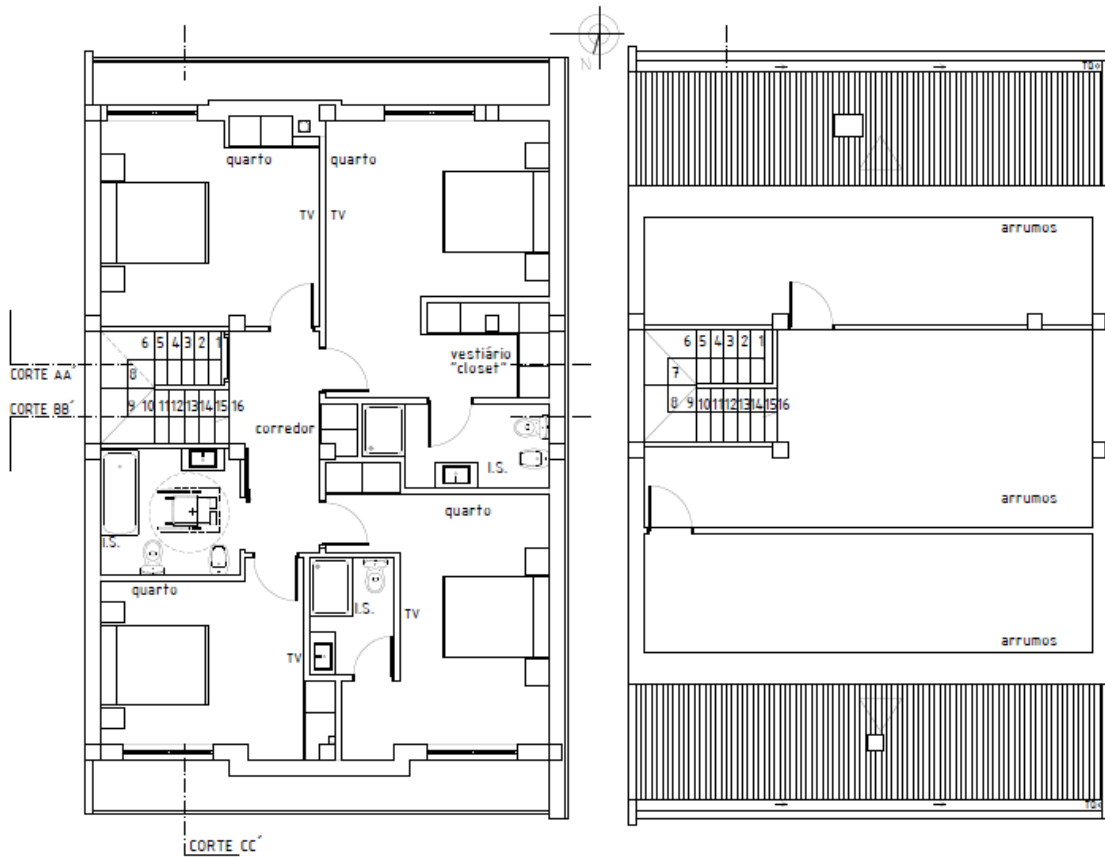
Planta baixa do 1º piso à esquerda e planta baixa do sótão à direita.
